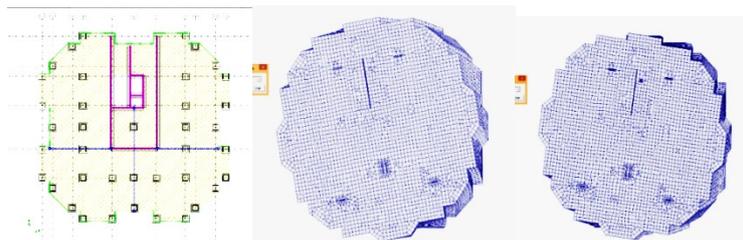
Первоначальный вариант плана здания и собственные колебания здания по 1-й и 2-й формам
